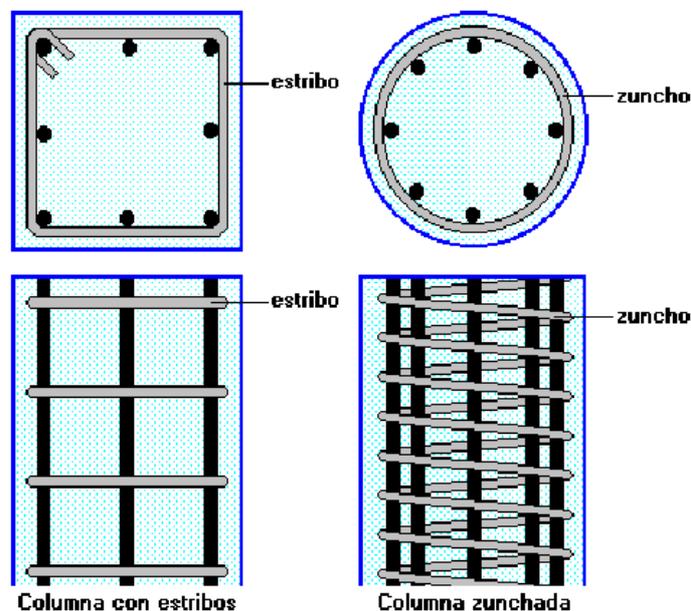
Tipos de armado de columnas. (PROAÑO, 2010)
